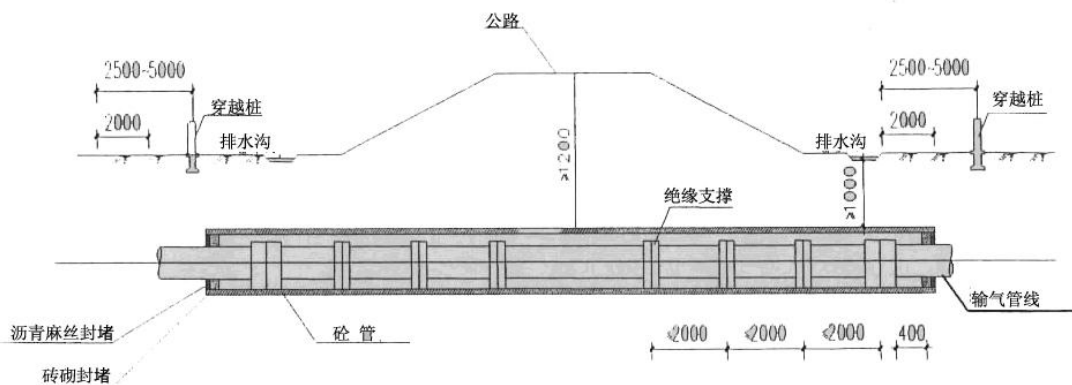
土路、砂石路穿越施工方式断面示意图
